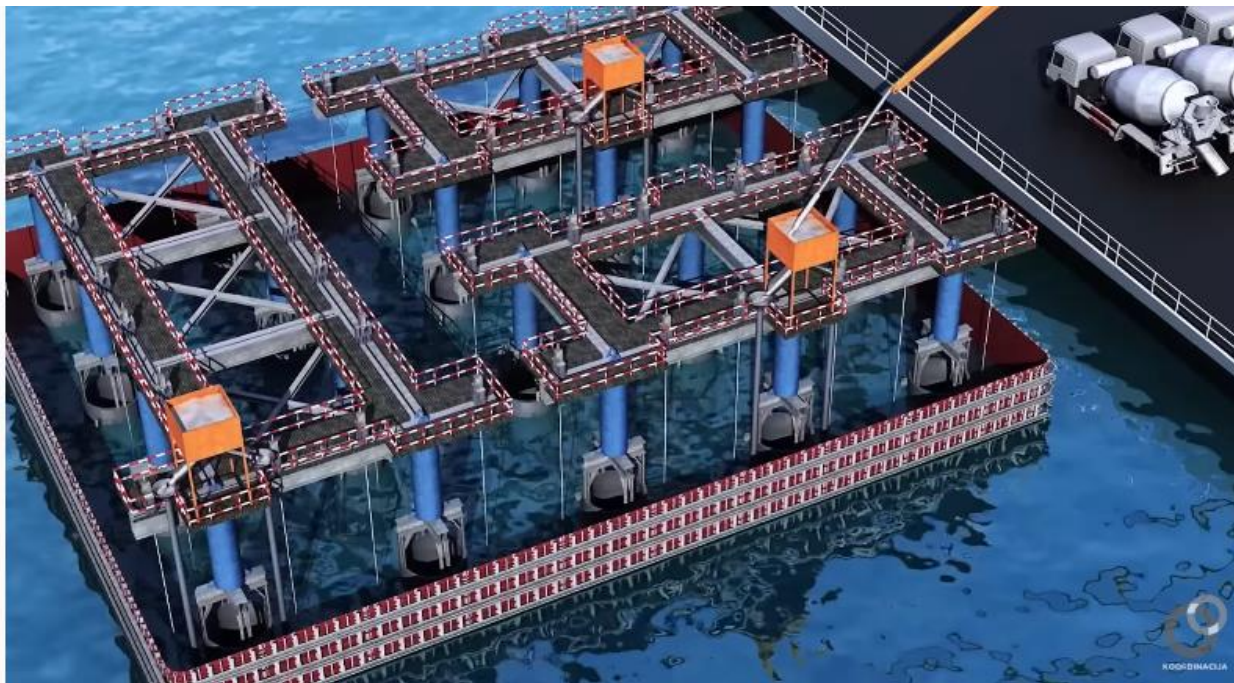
Specijalna dizalica koja prikazuje dizanje pilota
